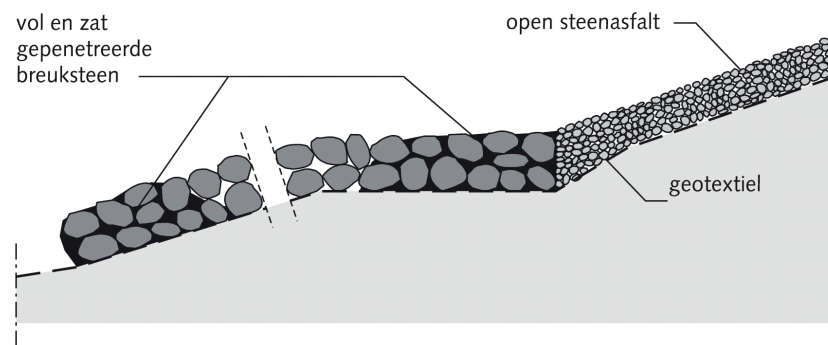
VOORBEELD VAN EEN STARRE TEENCONSTRUCTIE [1]
